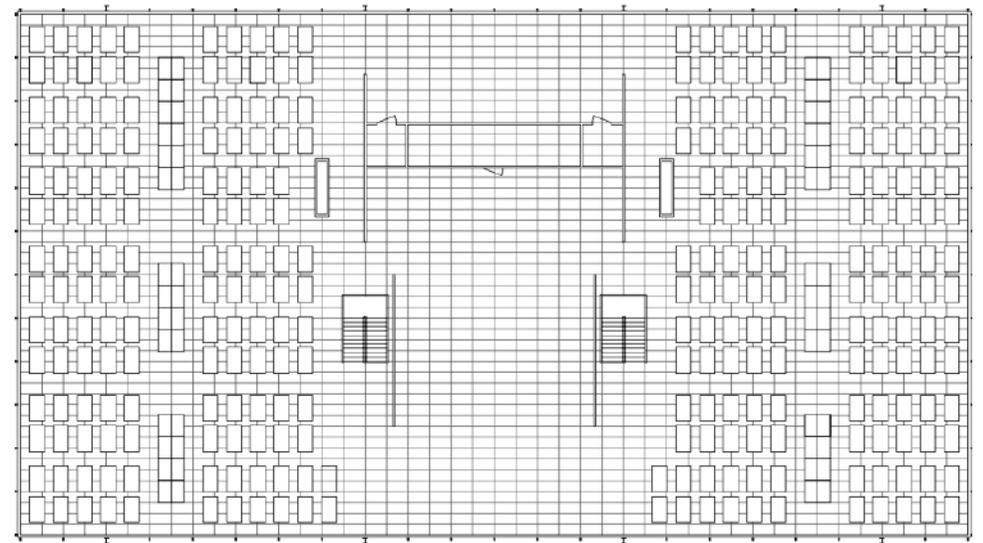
Crown Hall. Encaje de la disposición de las mesas en la planta principal-Diciembre 1955
